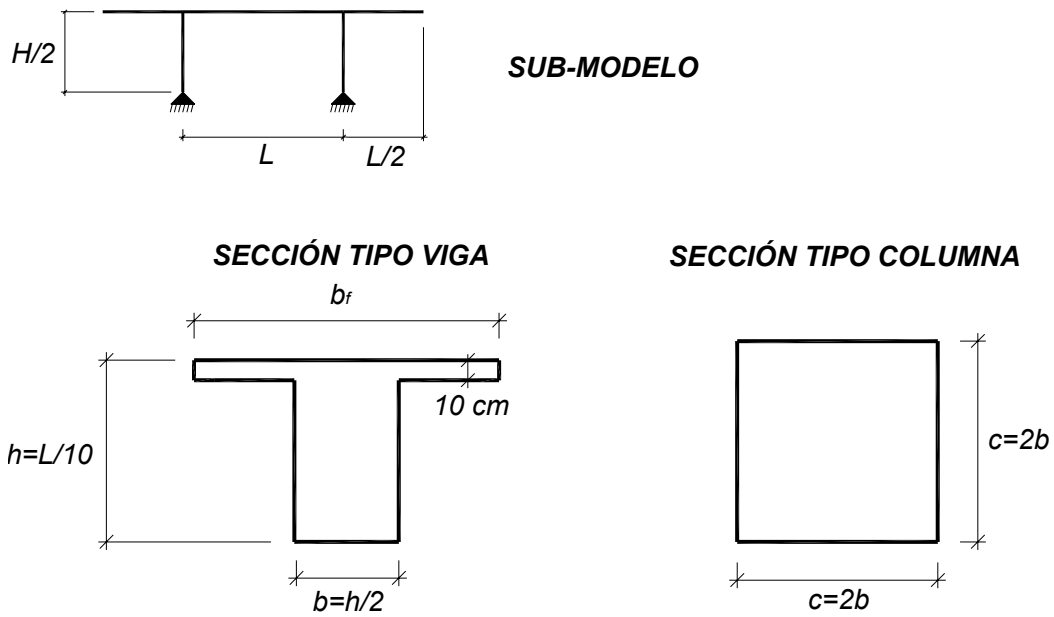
Secciones tipo de viga y columna del sub-modelo
